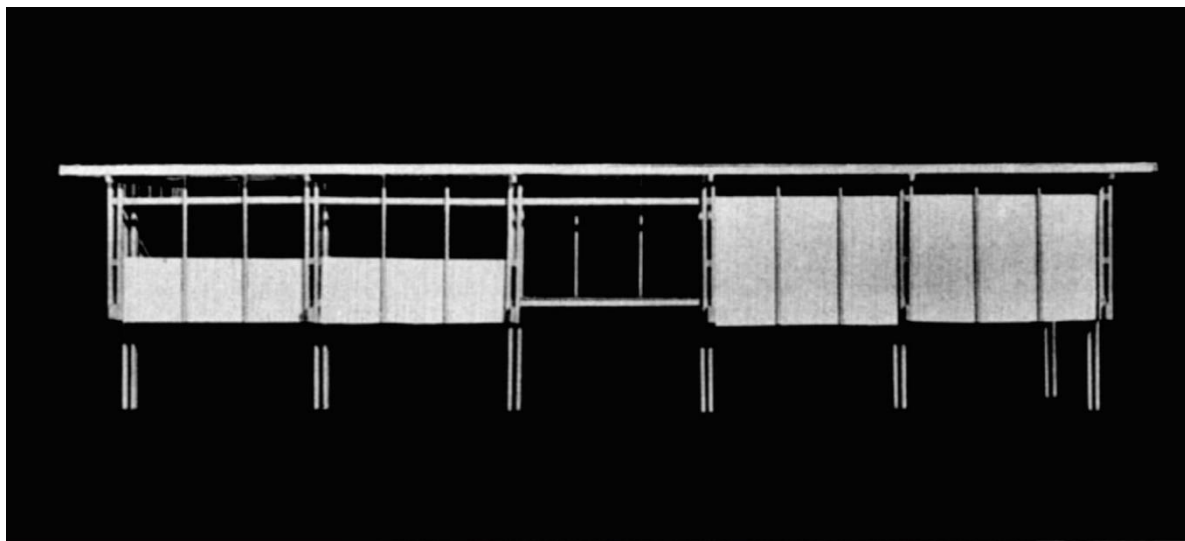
Fachada do pavilhão de 65m<sup>2</sup> executado em maquete. Fonte: Pedrosa (1960, p. 6).
